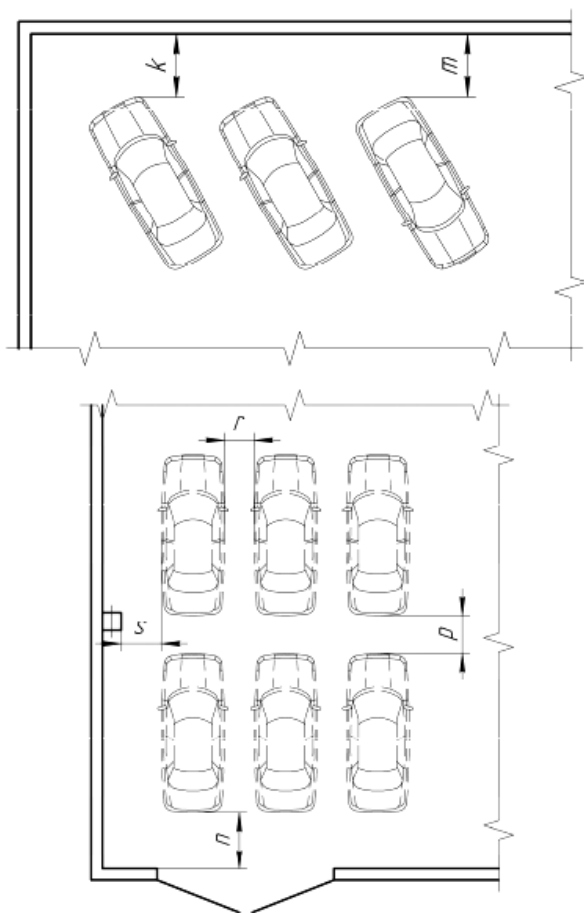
Нормативные расстояния между подвижным составом и элементами строительных конструкций зданий в зонах ожидания и хранения автомобилей
